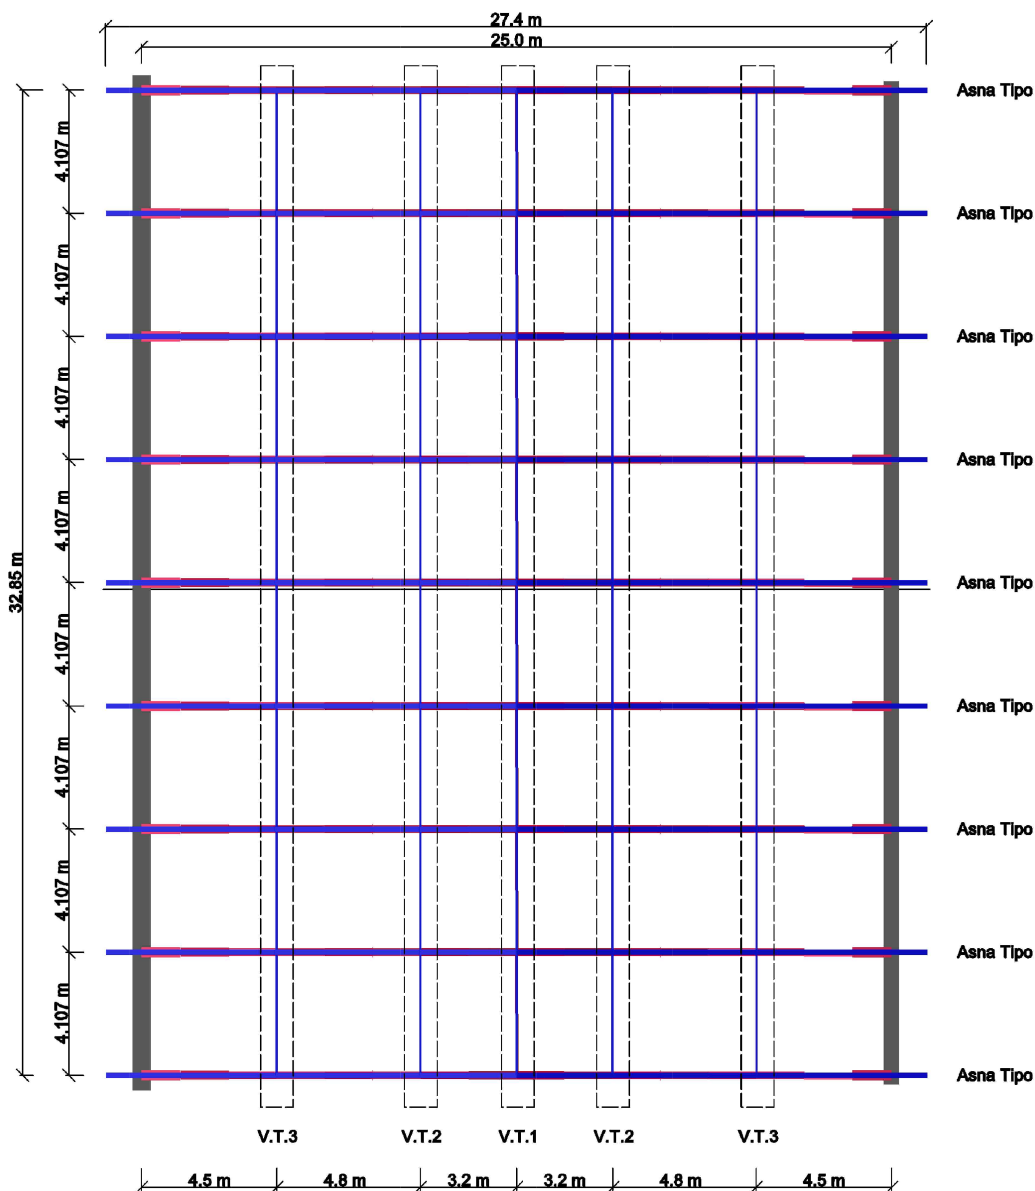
Vigas de travamento entre asnas - vista em planta.
